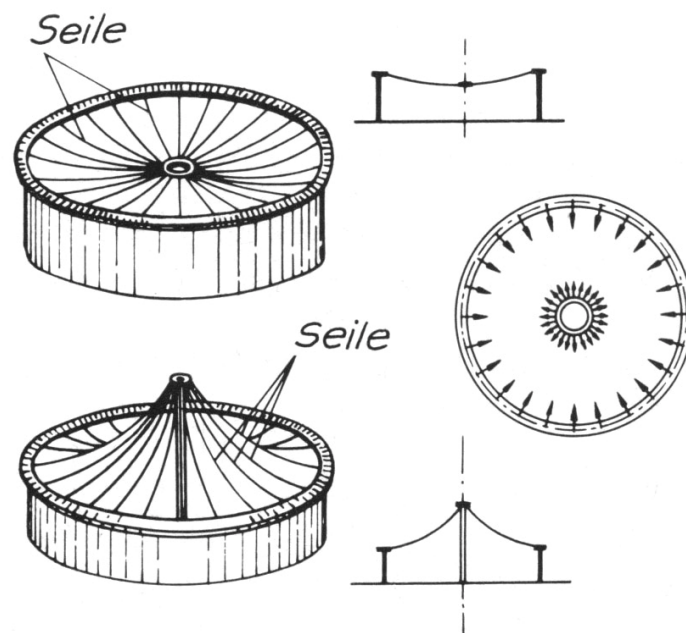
Hängedach über kreisrundem Grundriss mit innerem Zugring (oben) und mit Innenstütze (unten)
